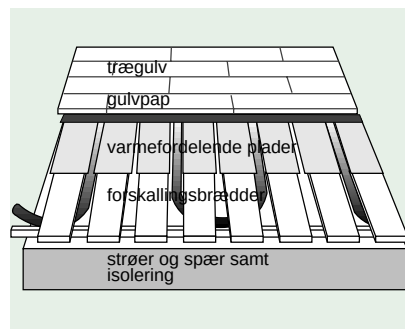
Eksempel på gulvvarmekonstruktion i trægulv.
